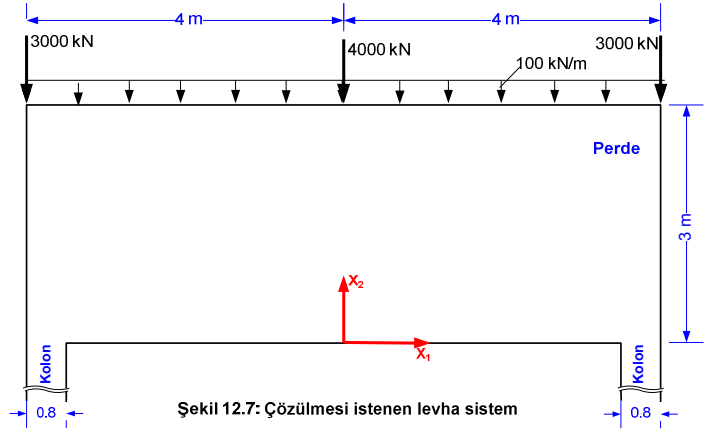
de görülen, 8x3 m boyutlu ve 0.25 m kalınlığındaki betonarme perde rijit kolonlara oturmaktadır. Beton sınıfı C25/30 dur. Levhaya etkiyen yükler üst yapıdaki kolonlardan, duvar ve döşemelerden gelmektedir. Bu yüklerden perdede oluşan σ_{11} , σ_{22} ve σ_{12} gerilmeleri hesaplanacak ve bazı kesitlerdeki dağılımları çizilecektir.
